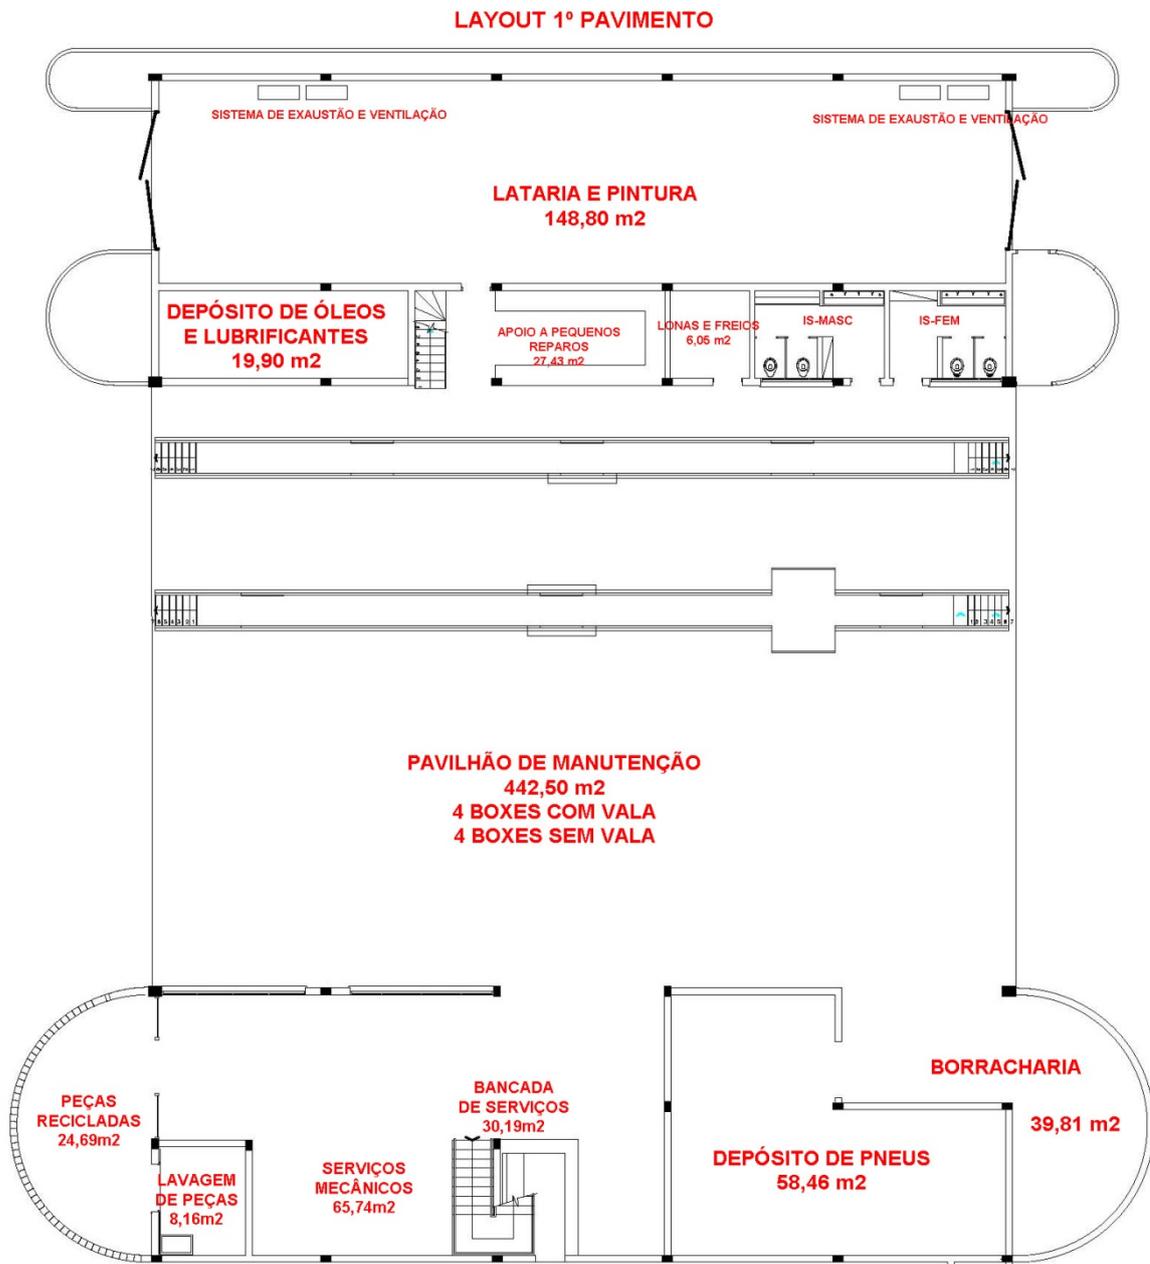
Lay Out da Oficina Mecânica - 1º Pavimento
